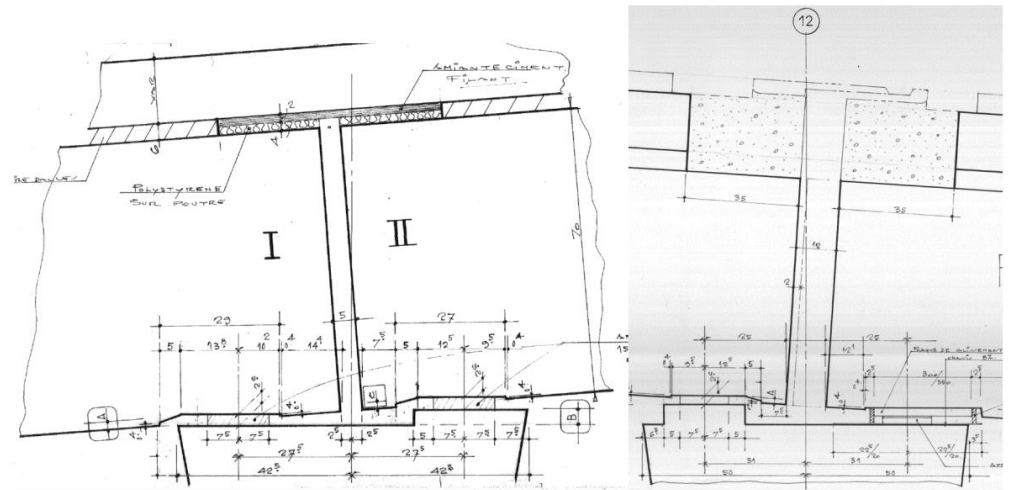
Chevêtre P11 [Gauche] - Chevêtres P12 [Droite]
